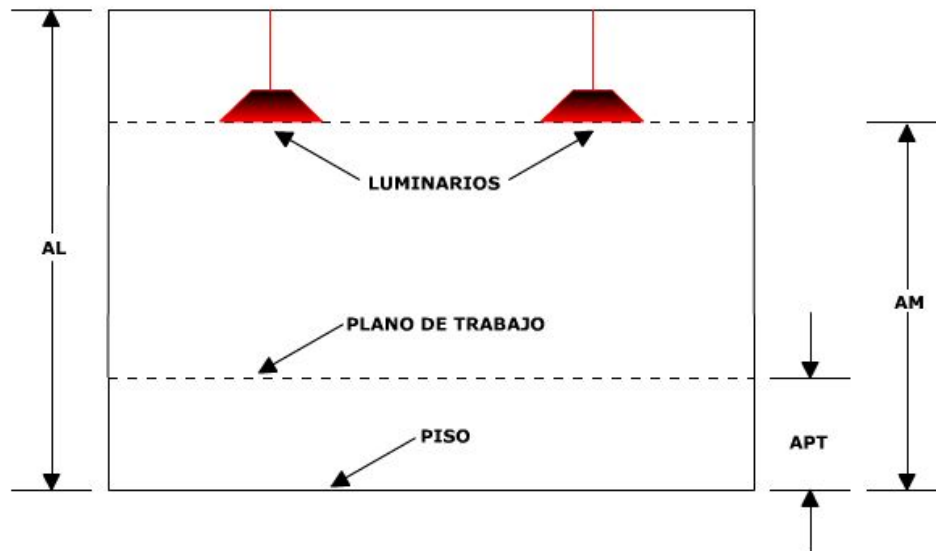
Parámetros arquitectónicos para el cálculo de iluminación
